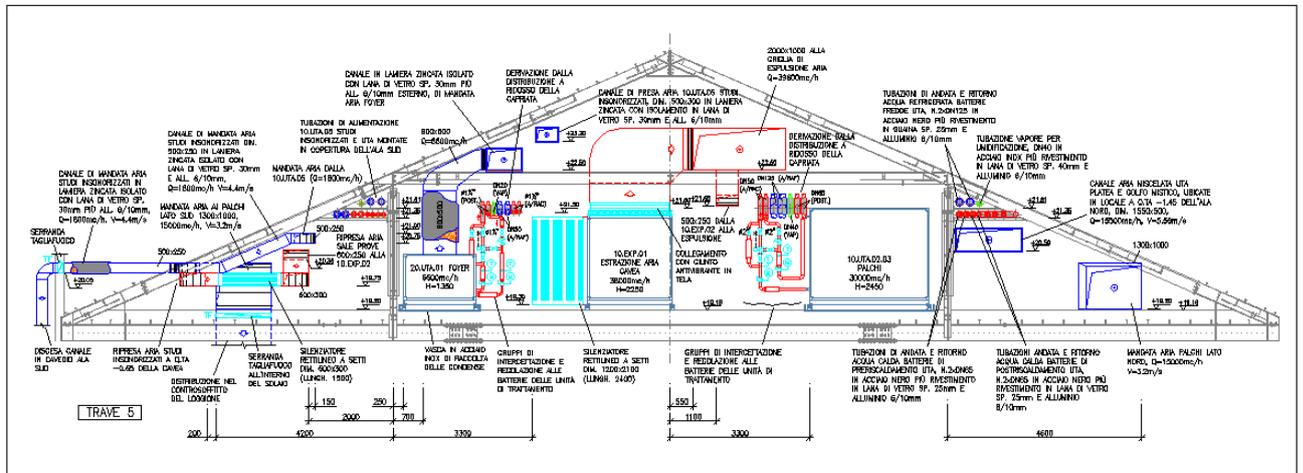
Sezione del Soffittone con inserimento centrali di trattamento aria.
